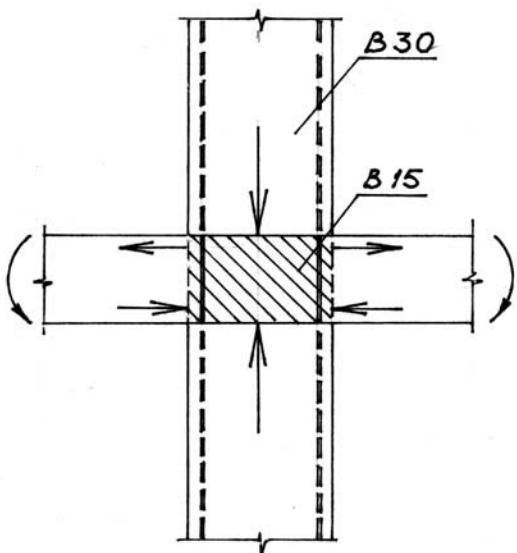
Соединение монолитного перекрытия со сборной колонной
